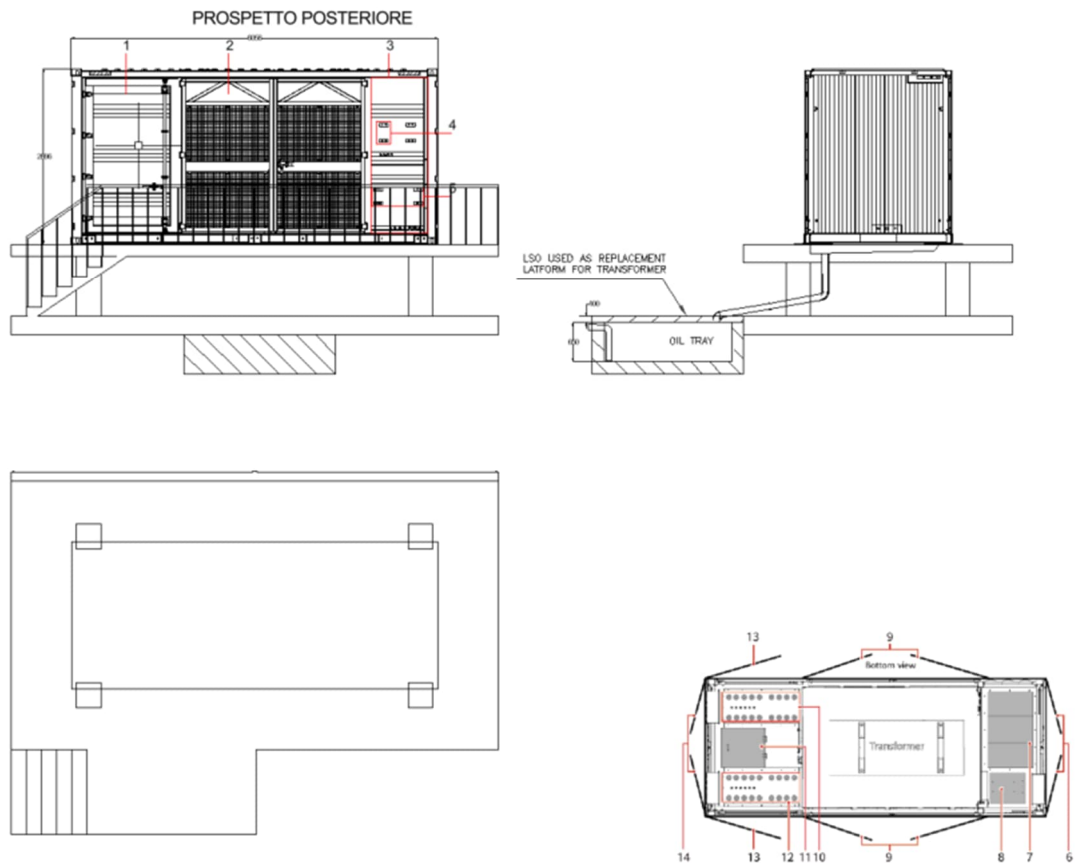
Tipologico delle Transformation Unit - Pianta e prospetto
